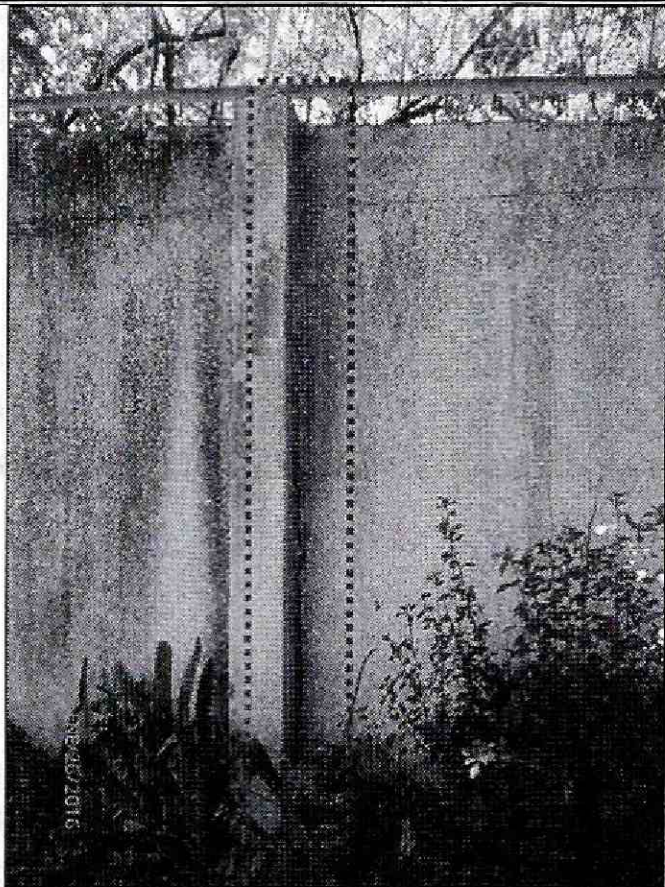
Fisura longitudinal en la placa de entepiso de la vivienda de la Carrera 70 A No. 123 - 03 en el Sector Catastral Niza Sur de la Localidad Suba, la cual es paralela a la fachada de la edificación.
